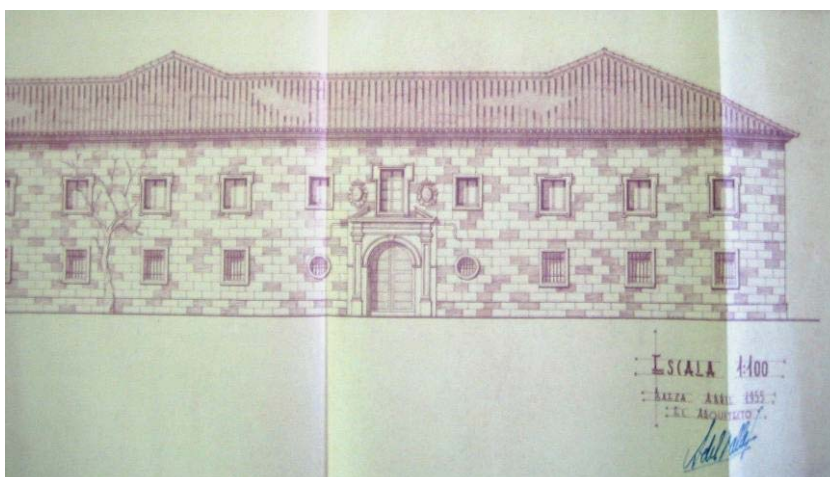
Alzado principal del conjunto a la cuesta de San Felipe Neri.
